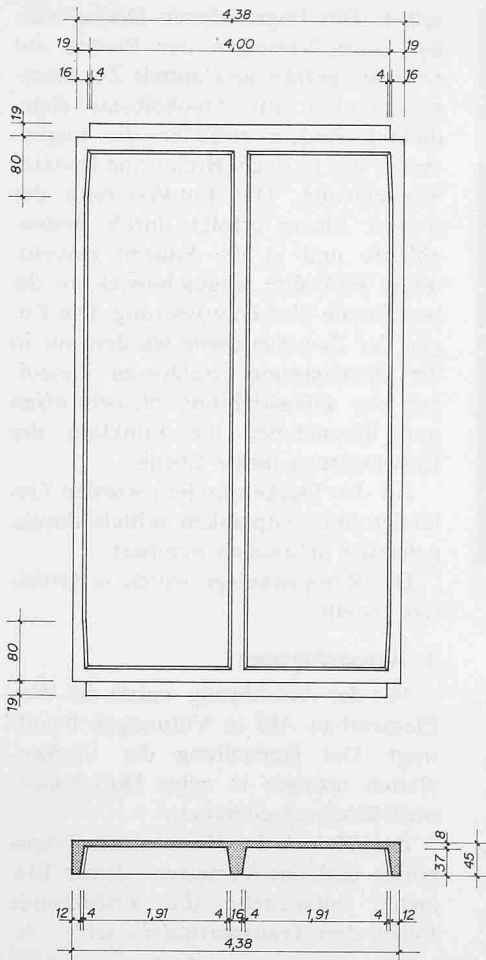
Deckenplatte der ersten Ebene, Massstab 1:100
